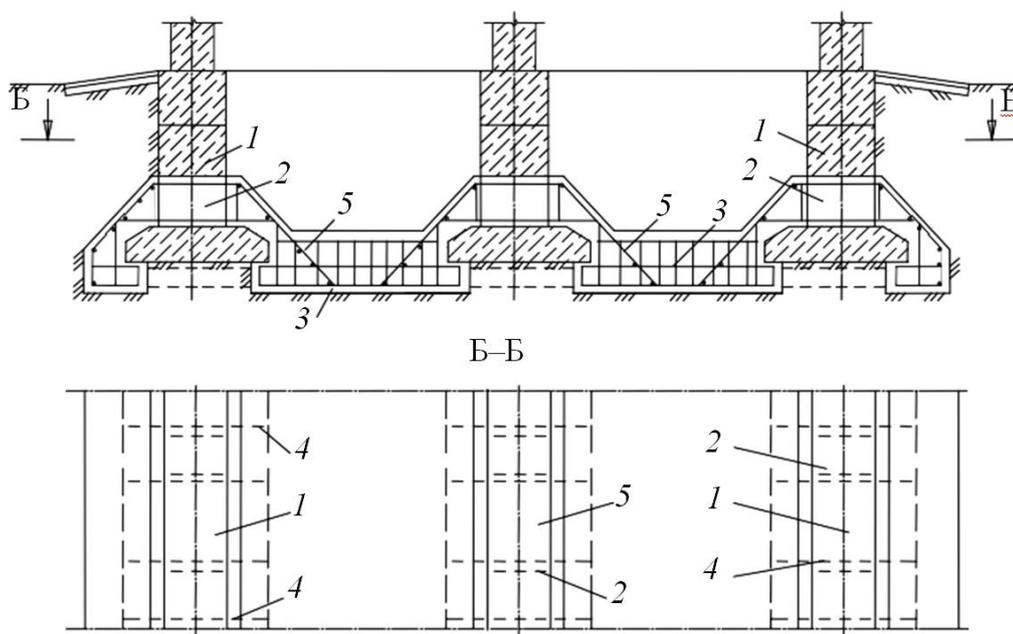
Переустройство ленточных фундаментов в плитные: 1 – ленточный фундамент; 2 – отверстия в ленточном фундаменте; 3 – подводящая плита; 4 – пропуски плиты под ленточным фундаментом; 5 – арматурные каркасы
